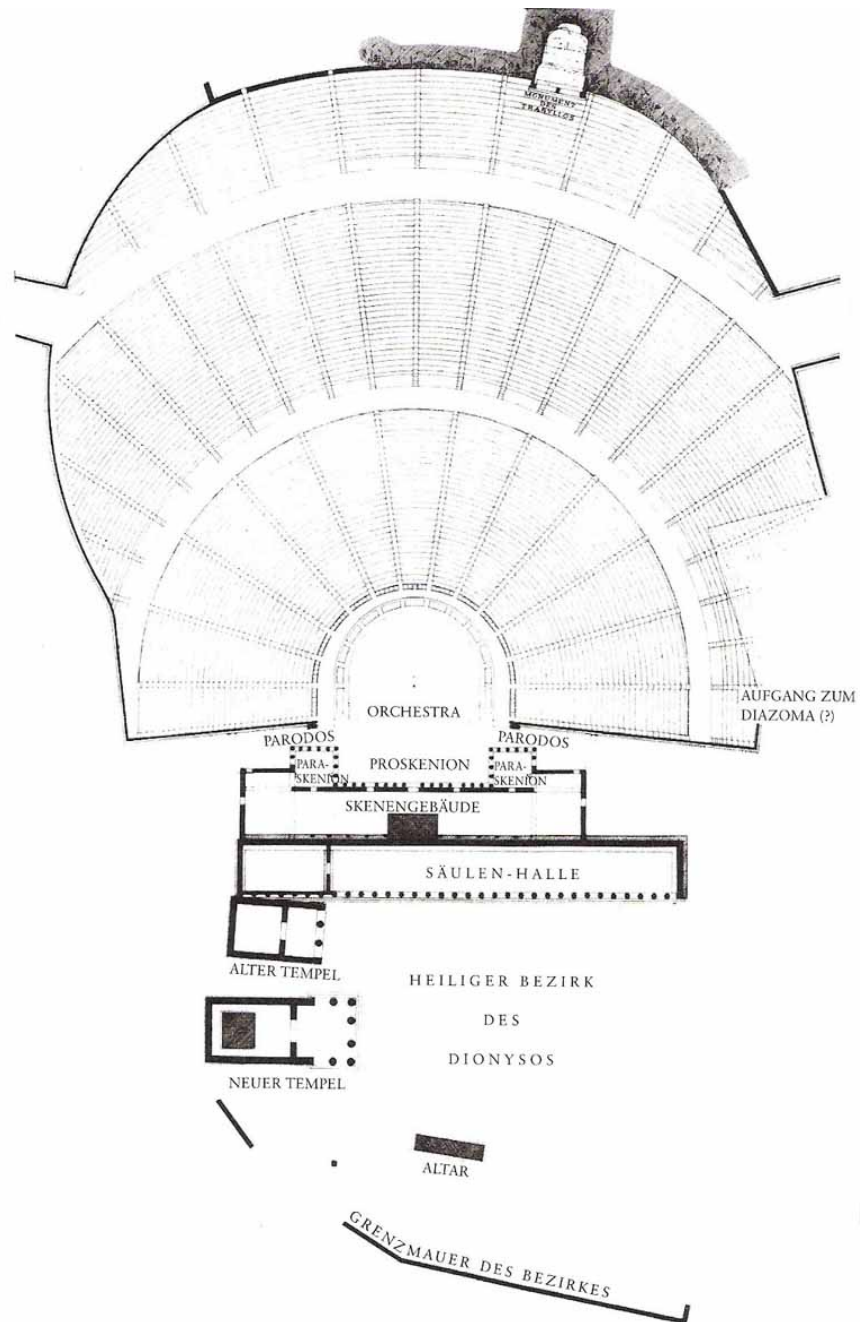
Grundriss des Dionysostheaters nach dem Umbau im 4. Jh. v. Chr.<sup>83</sup>
